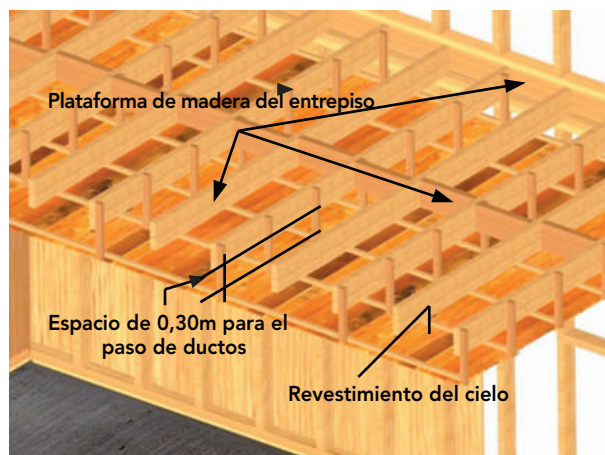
Cielo falso para el paso de ductos de alcantarillado.
